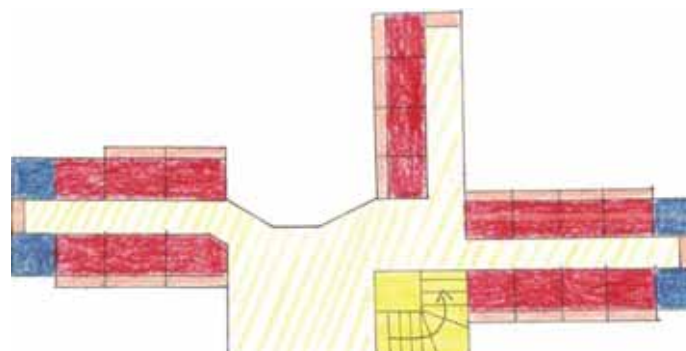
Planta do segundo pavimento do novo bloco da USP. Fonte: FERRO, 2010.
